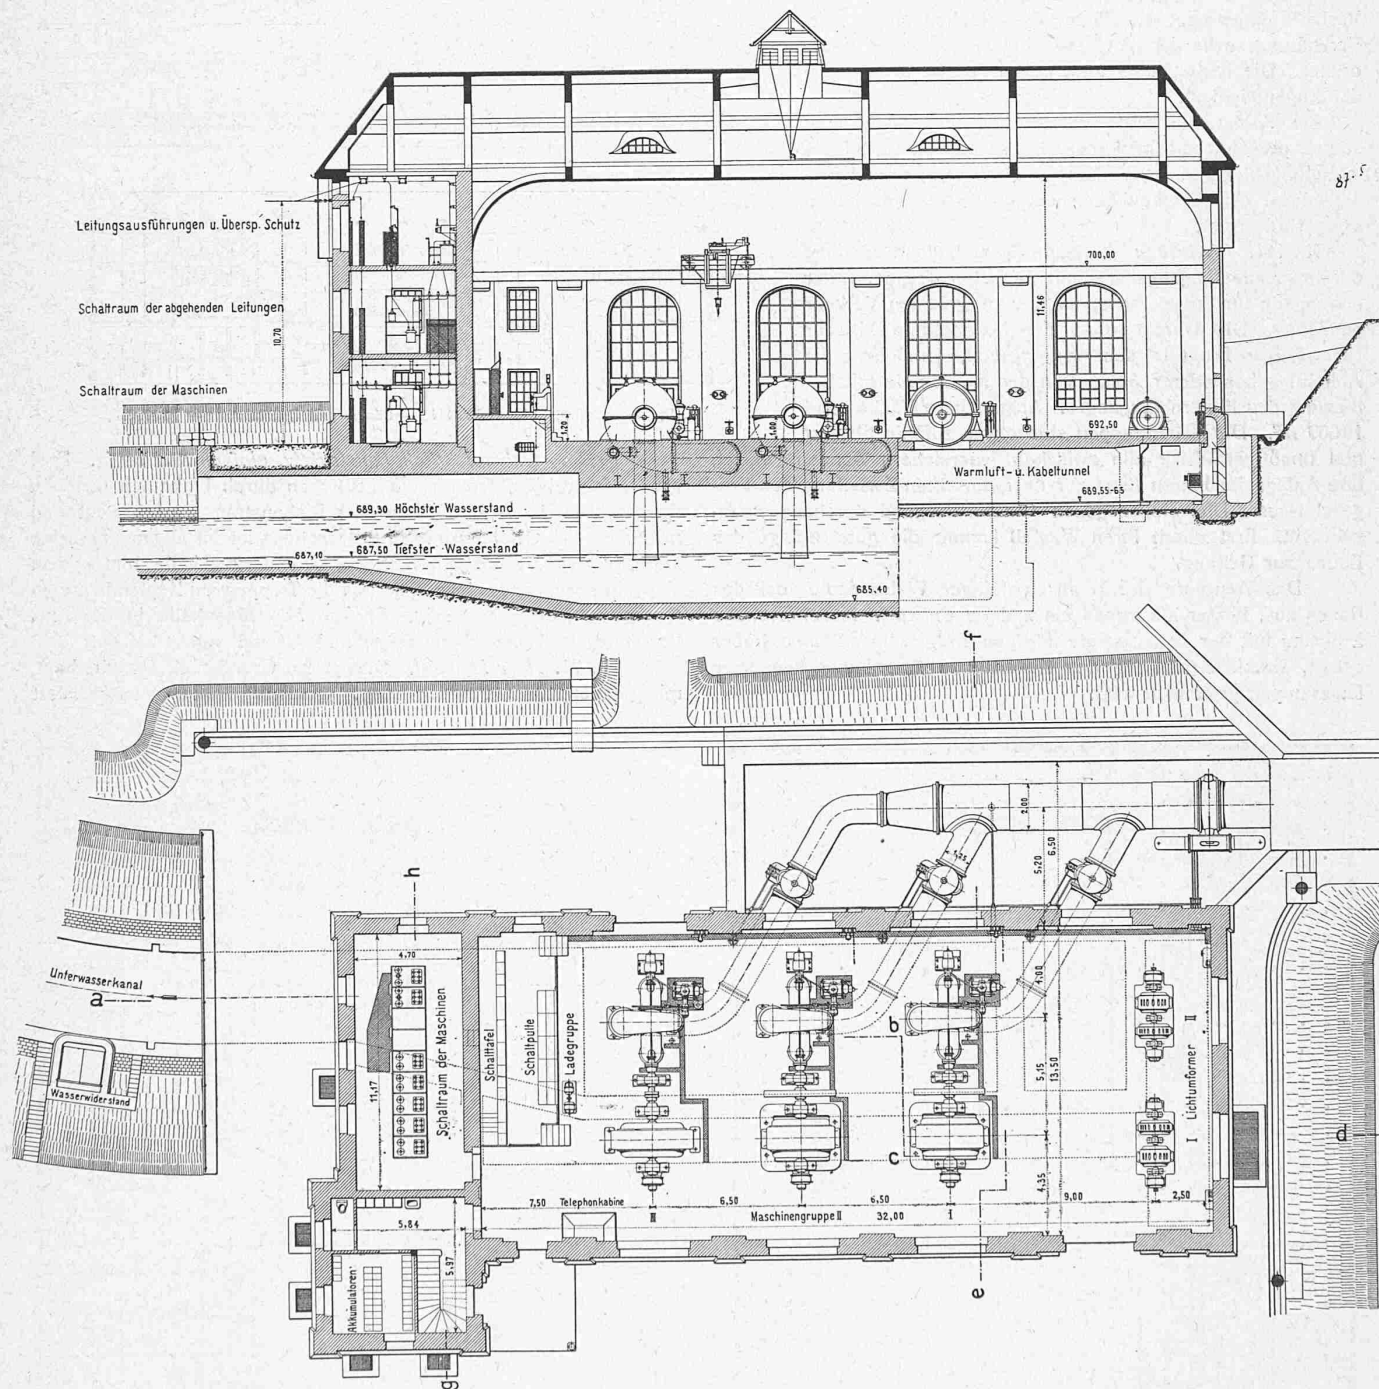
und 17. Grundriss und abgestufter Längsschnitt a-b-c-d des Maschinenhauses. — Masstab 1 : 300.
